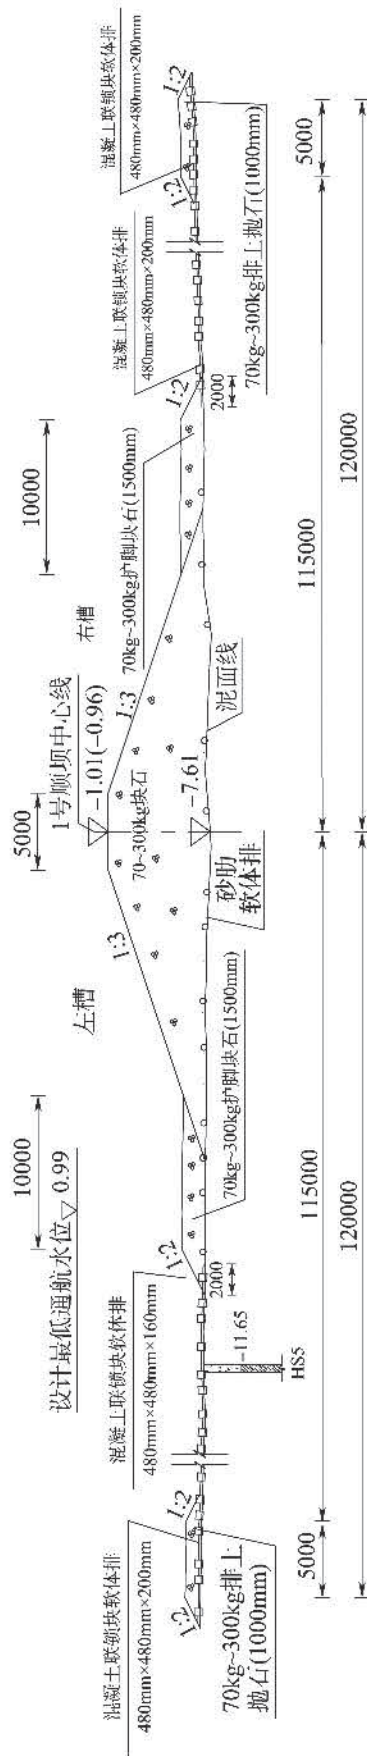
航道整治工程-长江下游某航道整治工程-顺坝断面示意图(尺寸单位:mm;高程单位:m)
